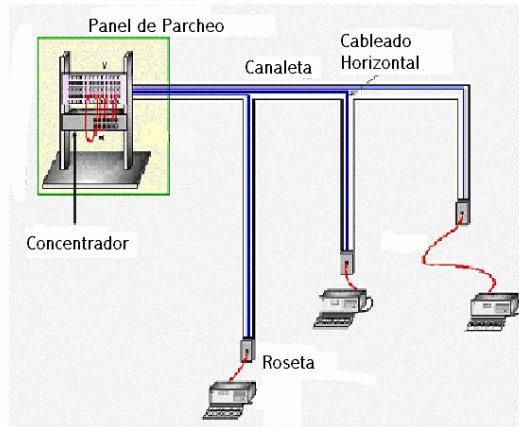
Cableado Horizontal con canaletas hasta las rosetas
